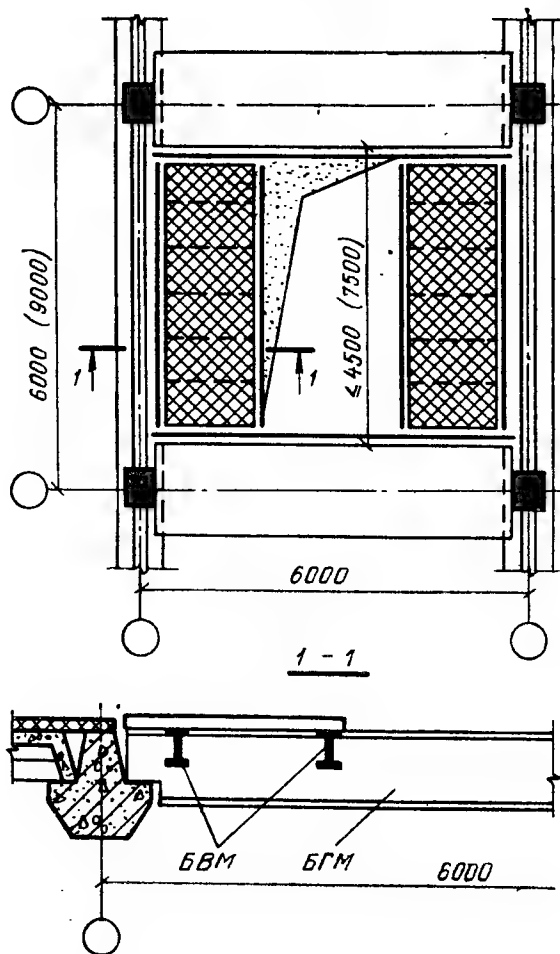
Монтажные панели с проемами для перекрытий типа 1
